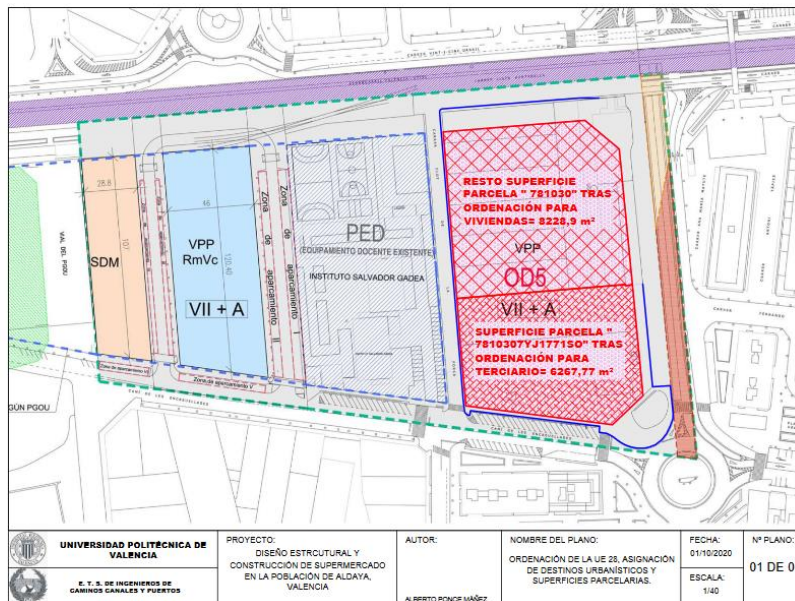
Disposición, montaje y medición de las parcelas correspondiente a la UE 28. Elaboración propia.
